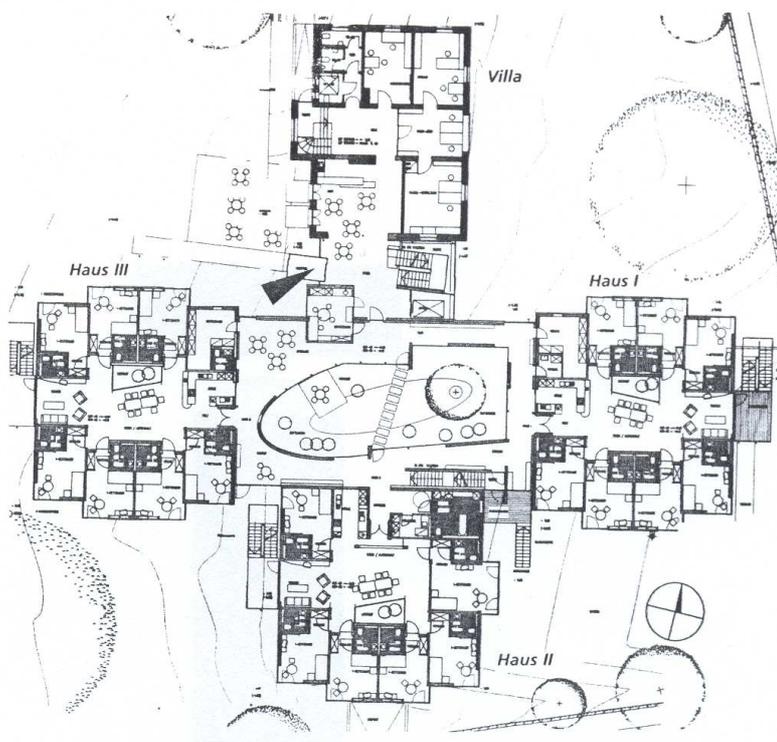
Grundrisszeichnung Dießen
